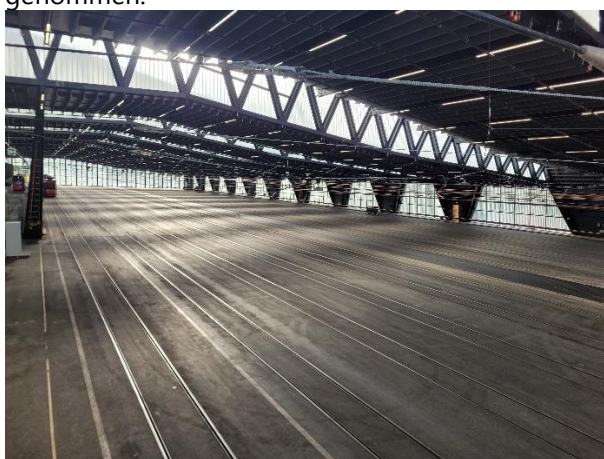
Bauprojekt Erweiterung Depot Bolligenstrasse
